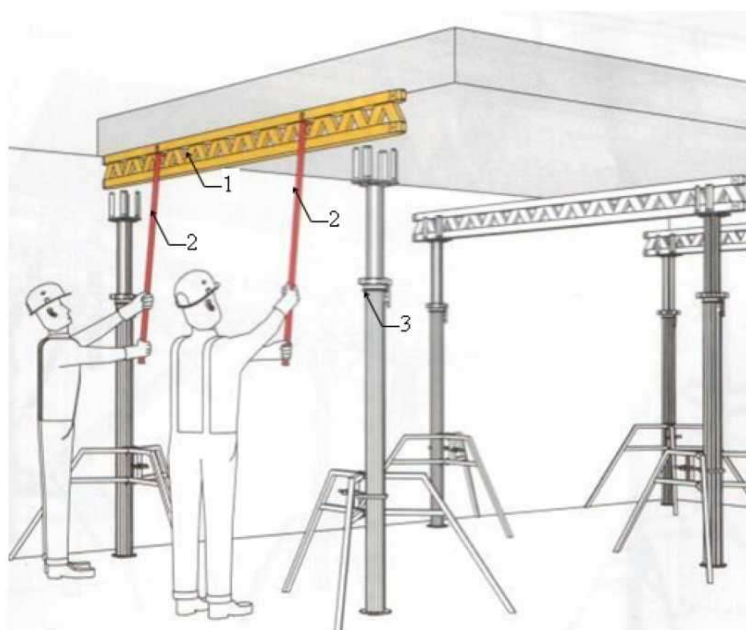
Демонтаж балок настила опалубки: 1 - продольная балка; 2 - монтажная штанга; 3 - основная стойка
